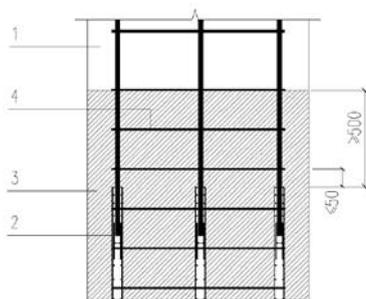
钢筋采用套筒灌浆连接时柱底箍筋加密区域构造示意
